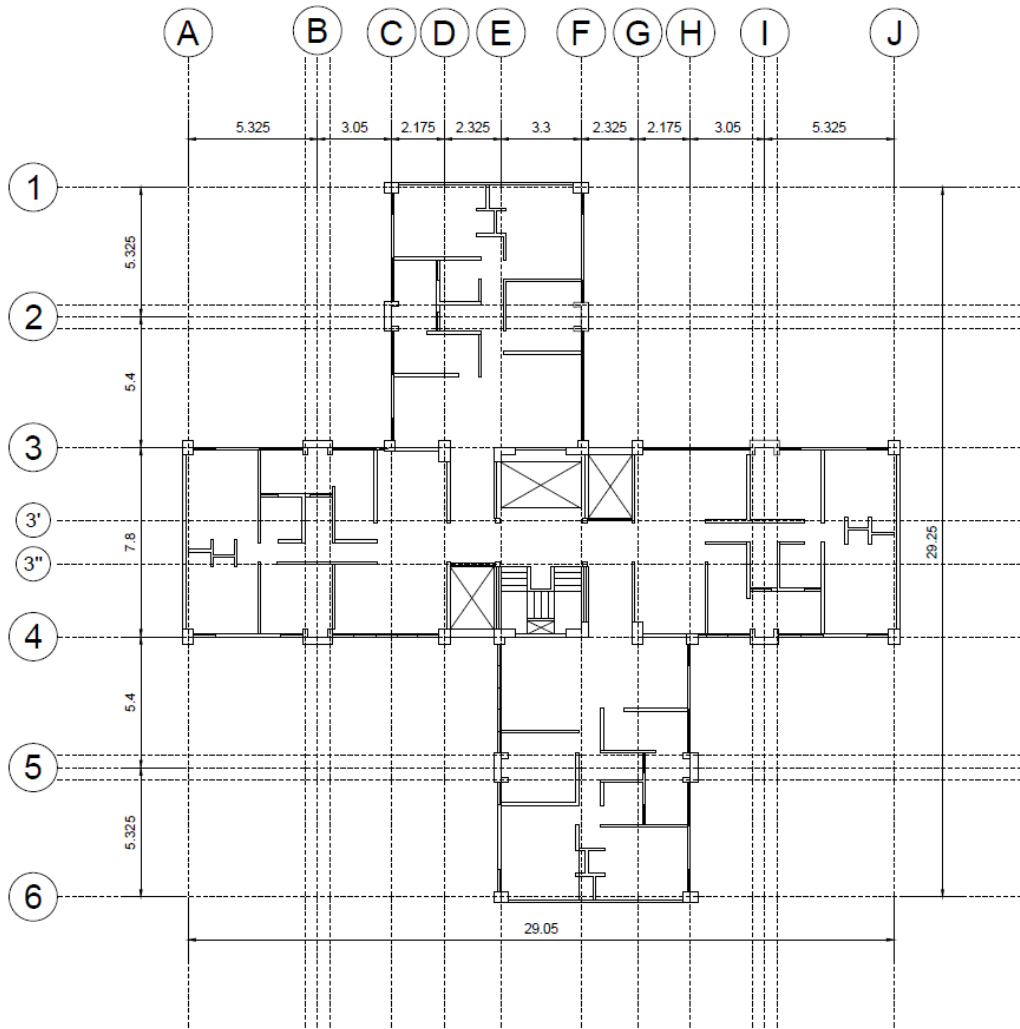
Croquis de la planta arquitectónica del conjunto
